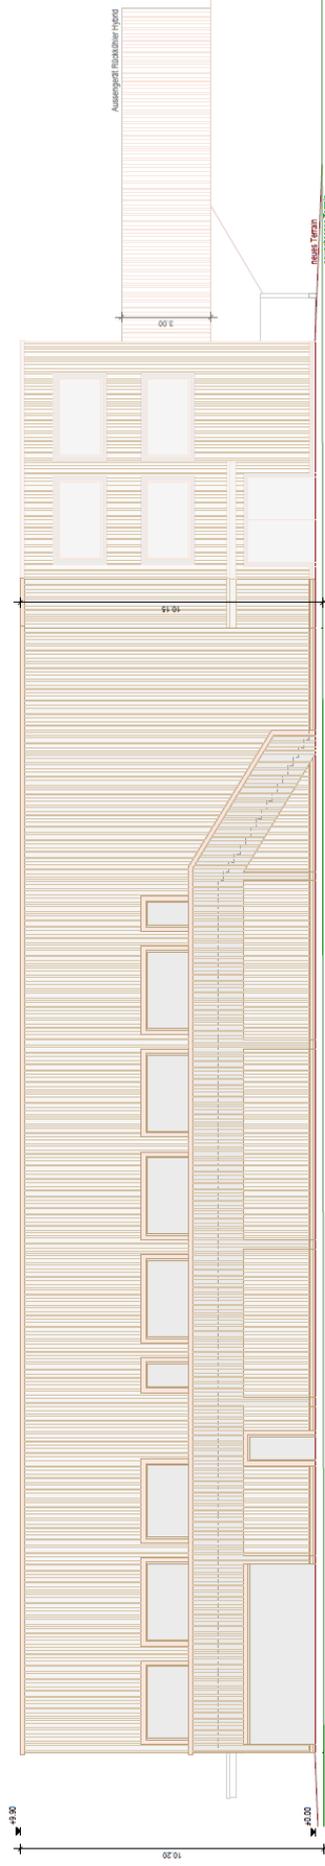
Ansicht Westfassade (Quelle: Ricci Architekten, Brig).
